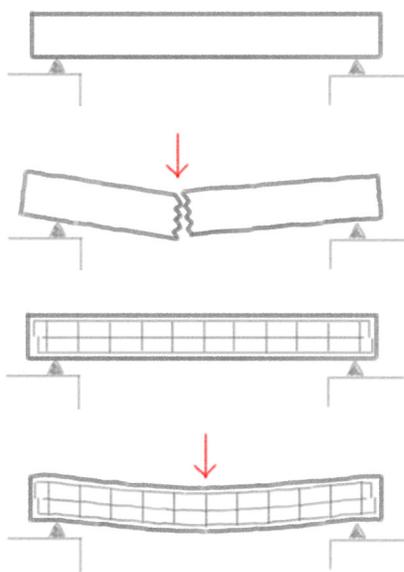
Esfuerzos hormigón armado. Elaboración propia.
